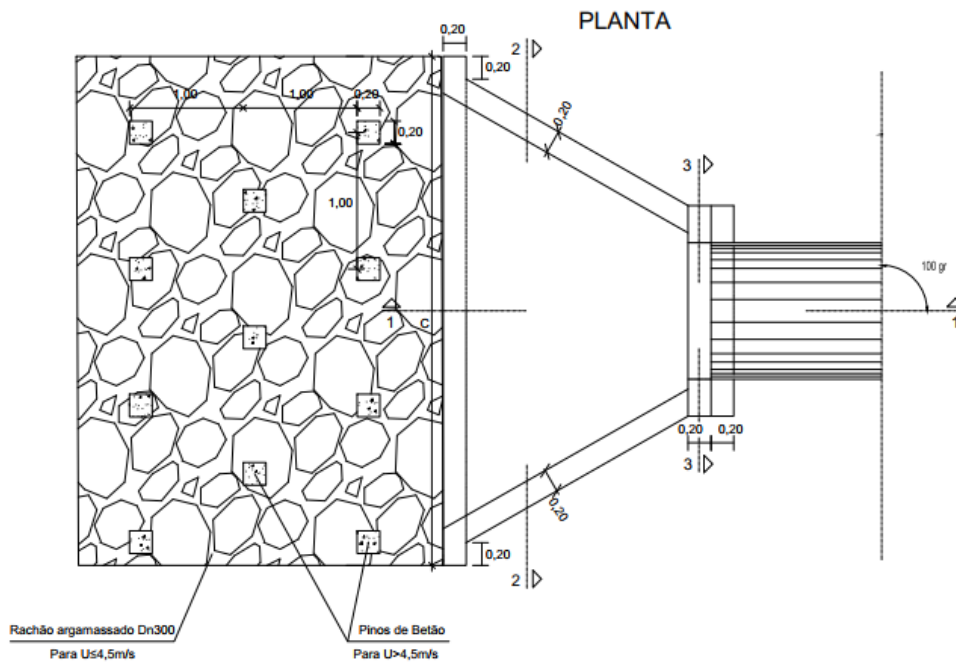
Detalhe de boca simples de aterro para passagem hidráulica em betão argamassado
